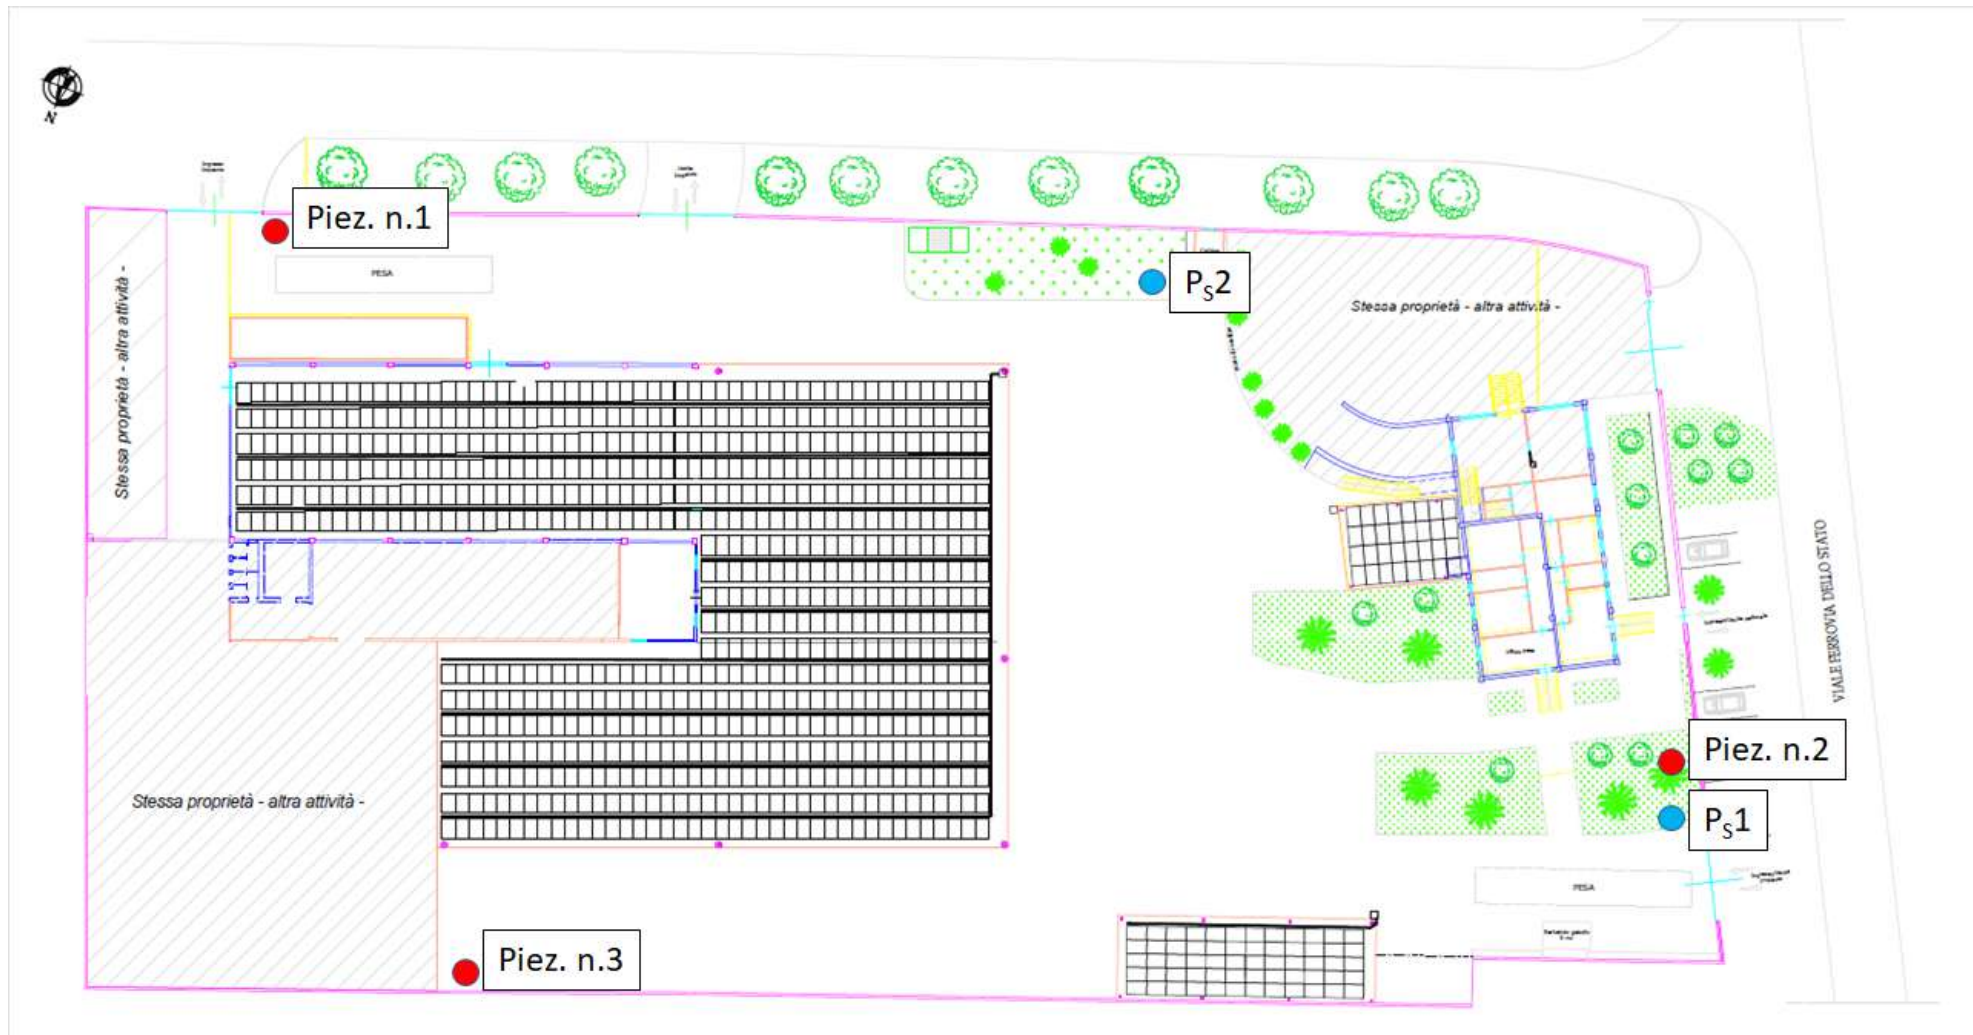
Planimetria generale con indicazione del posizionamento dei punti di monitoraggio
